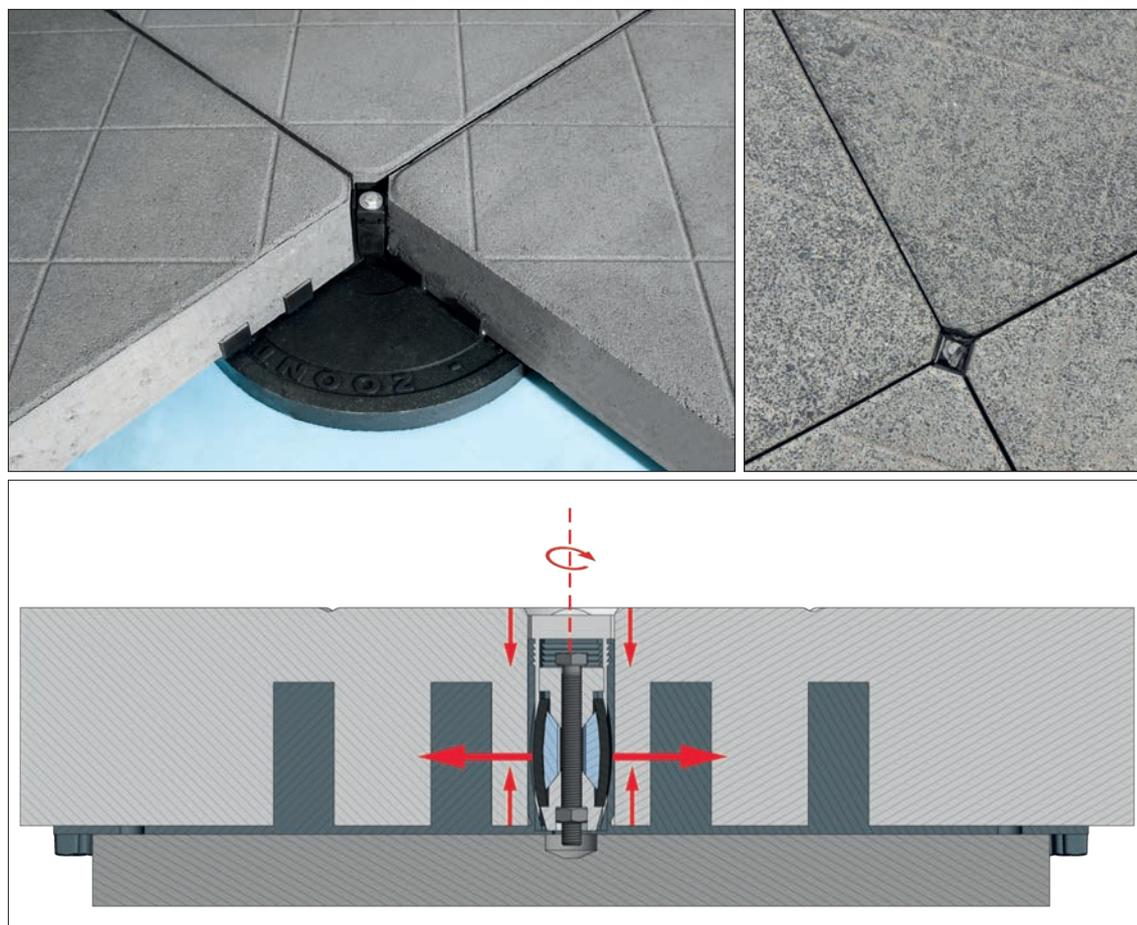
Exemple de système de serrage pour dalles de grand format pour toitures-parkings
